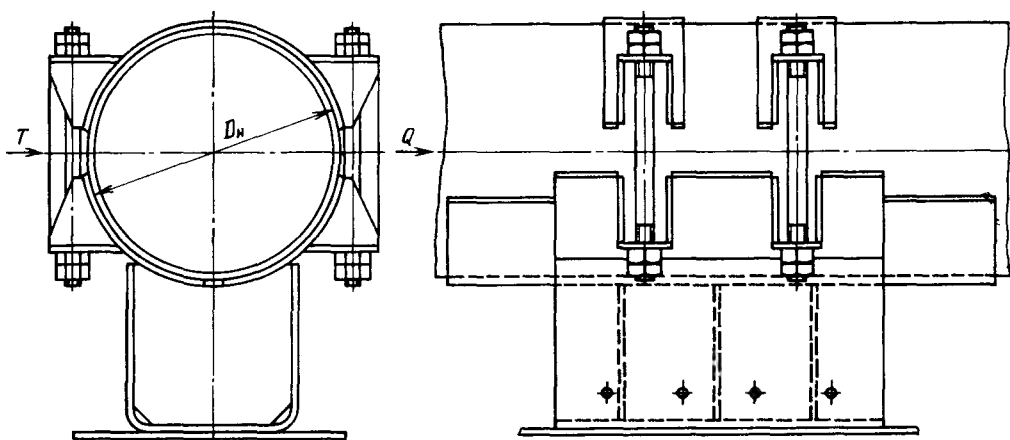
Опоры неподвижные надземной прокладки для трубопроводов  $D_n$  377 ÷ 1420 мм
